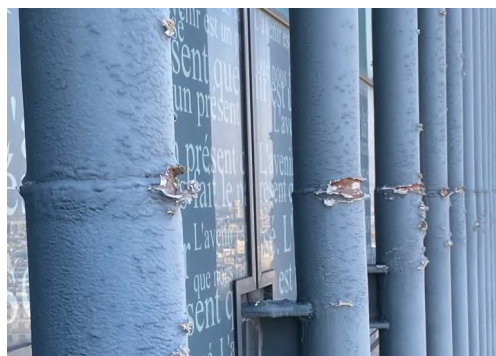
R+16 dégradation à la jonction entre tronçons de poteaux
